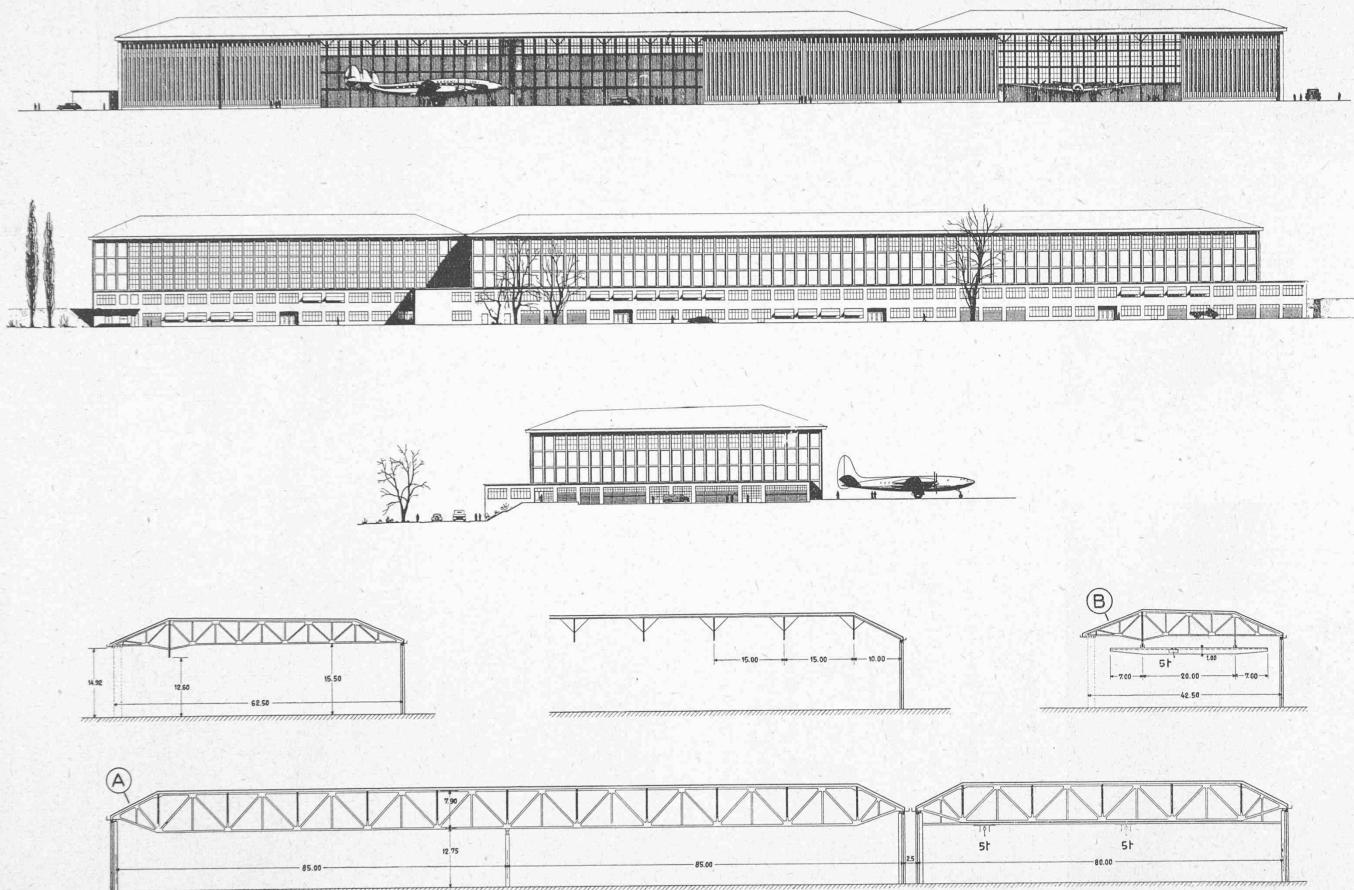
Hangar et halle de montage. — Face piste. — Façade côté ville. — Façade côté aéroport.
